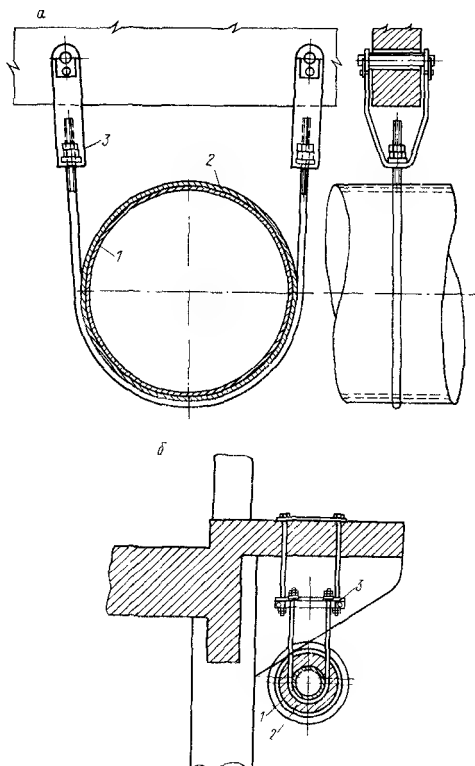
Подвеска газопровода под железобетонным мостом.
